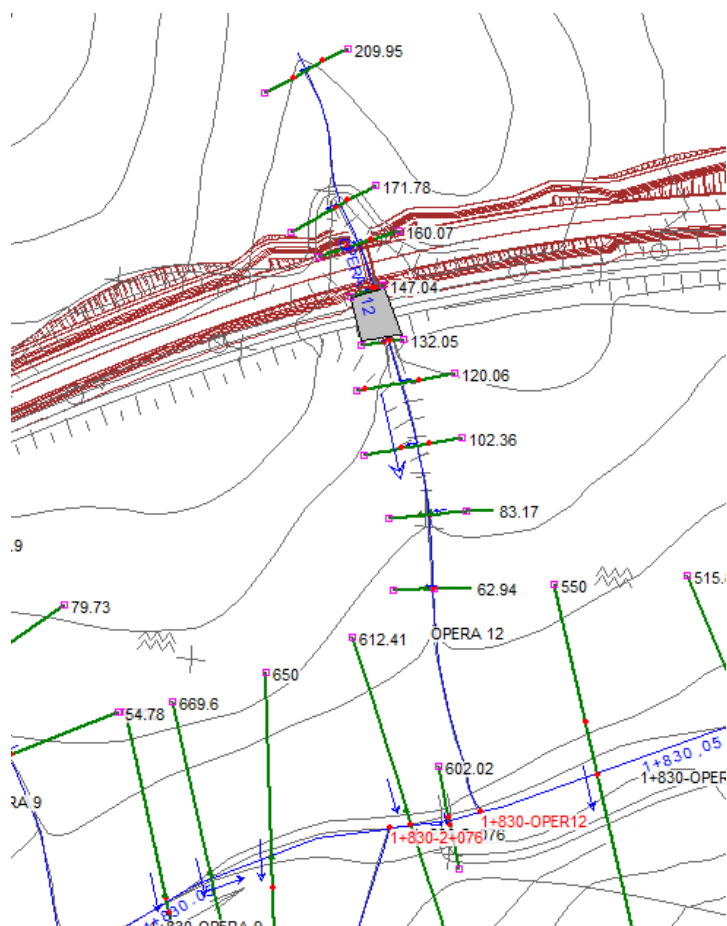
Planimetria Hec ras – sovrapposizione SDF – linea di progetto
